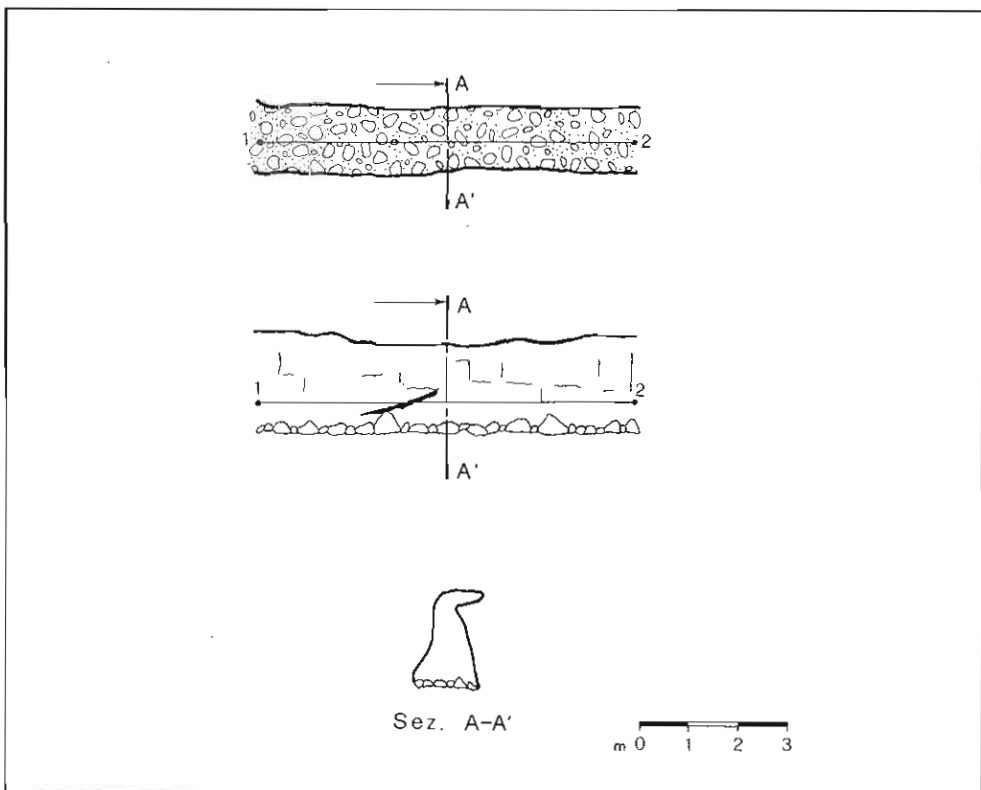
,12 - Riperto grafico di una sezione trasversale nella planimetria e sezione longitudinale
